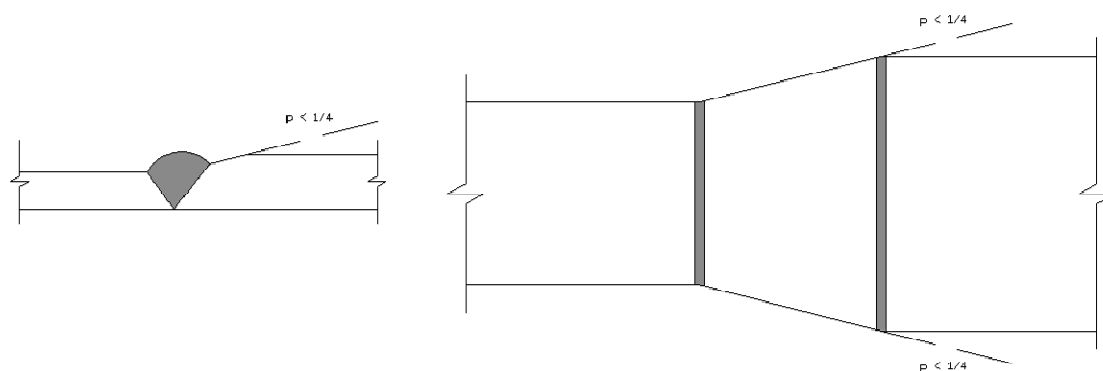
Soldadura de ligação dos banzo de diferentes dimensões.
